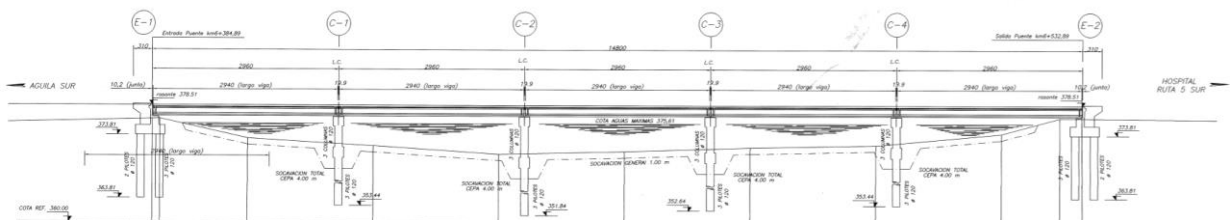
Elevación de Puente Águila Norte. Fuente: Planos Puente MOP [41].
